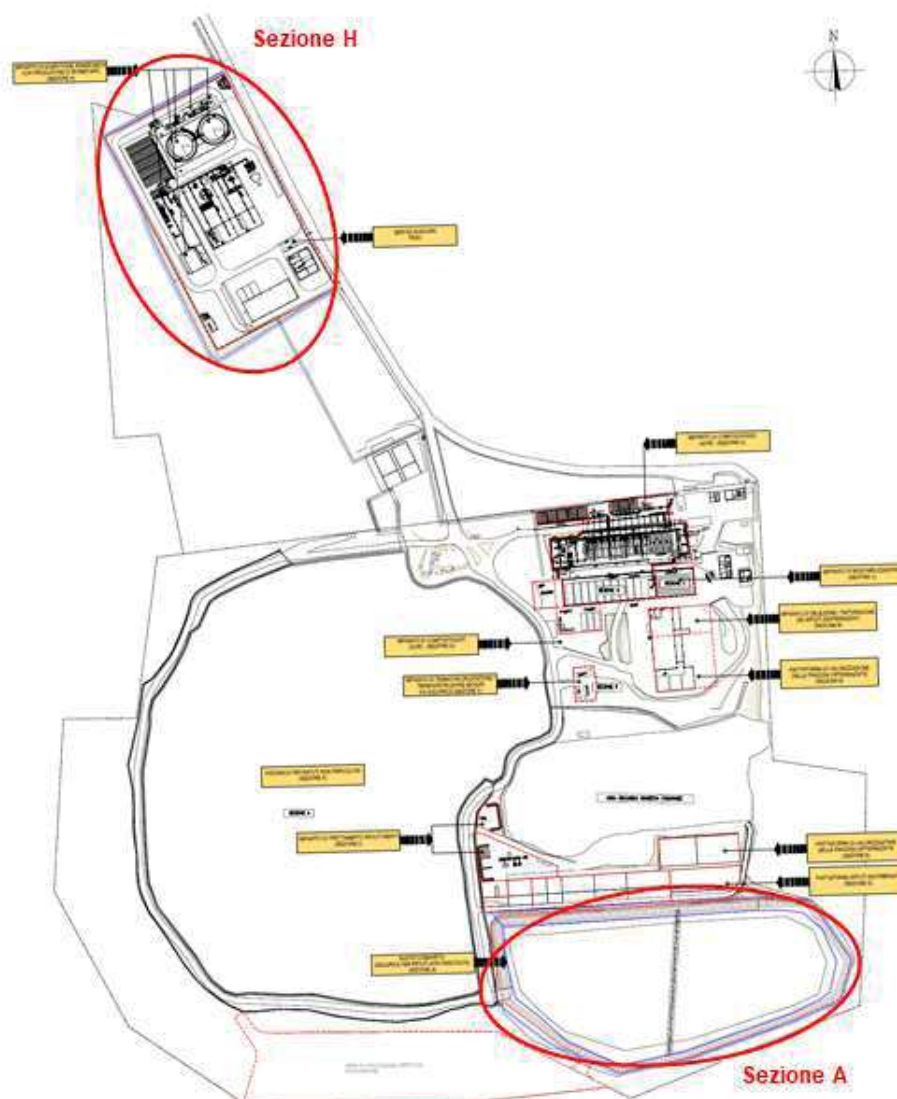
nuova configurazione di progetto dell'installazione IPPC consortile con indicazione (in rosso) delle aree interessate dalle principali attività di escavazione.
